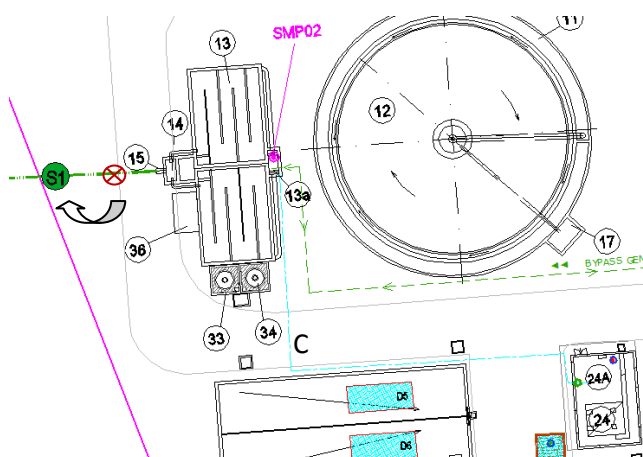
stralcio dell'elaborato Grafico EG.01b Planimetria stato di progetto
